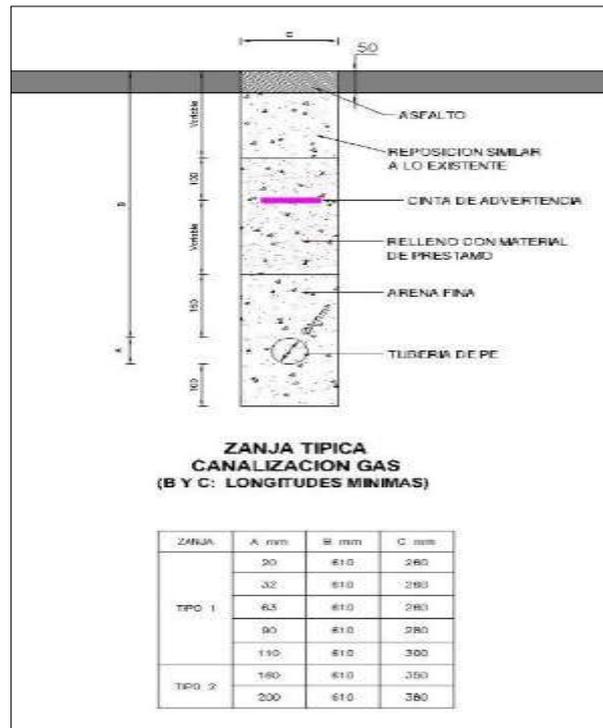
Plano Típico de Zanja para Tuberías de Polietileno
